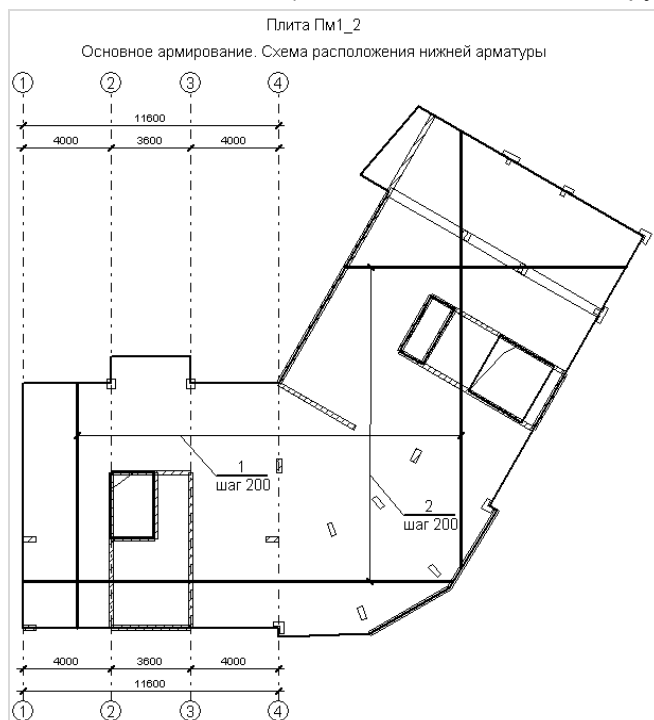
Схема раскладки стержней основного армирования, стиль для печати (фрагмент)
